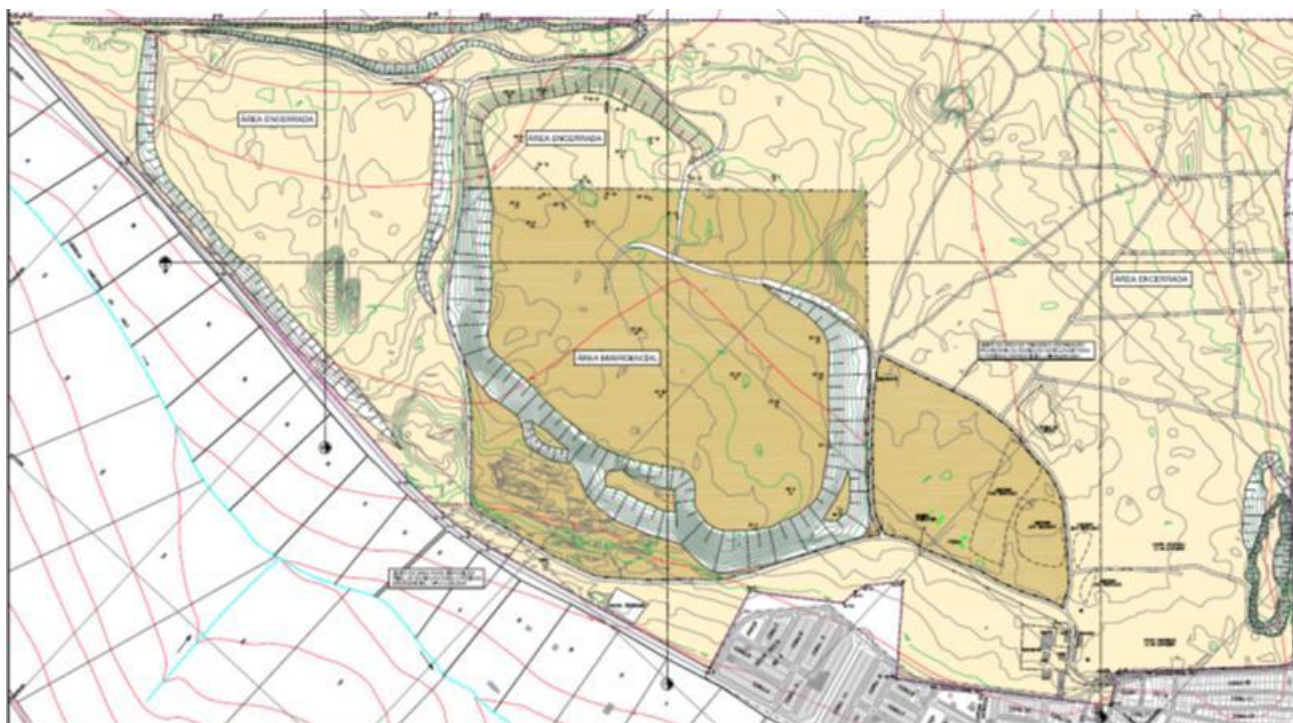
Planta de situação em 2009 e imagem 2014.
